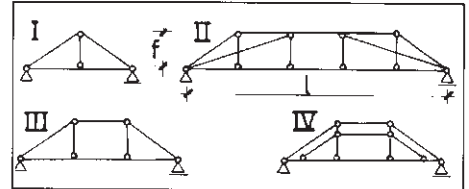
Mögliche statische Systeme: I) einfaches Hängewerk, II) vierfaches Hängewerk mit 4 Streben, III) zweifaches Hängewerk (Trapezhängewerk), IV) zweifaches Hängewerk mit doppelten Streben und Spannriegeln
